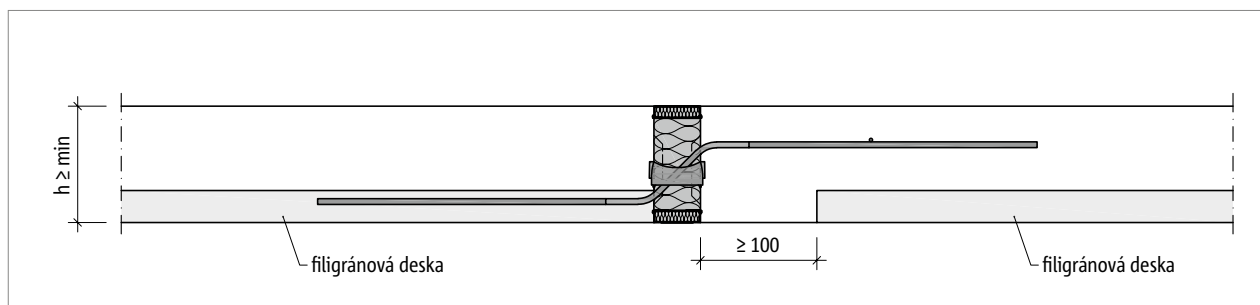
Schöck Isokorb® T typ QPN-CV50: Řez
